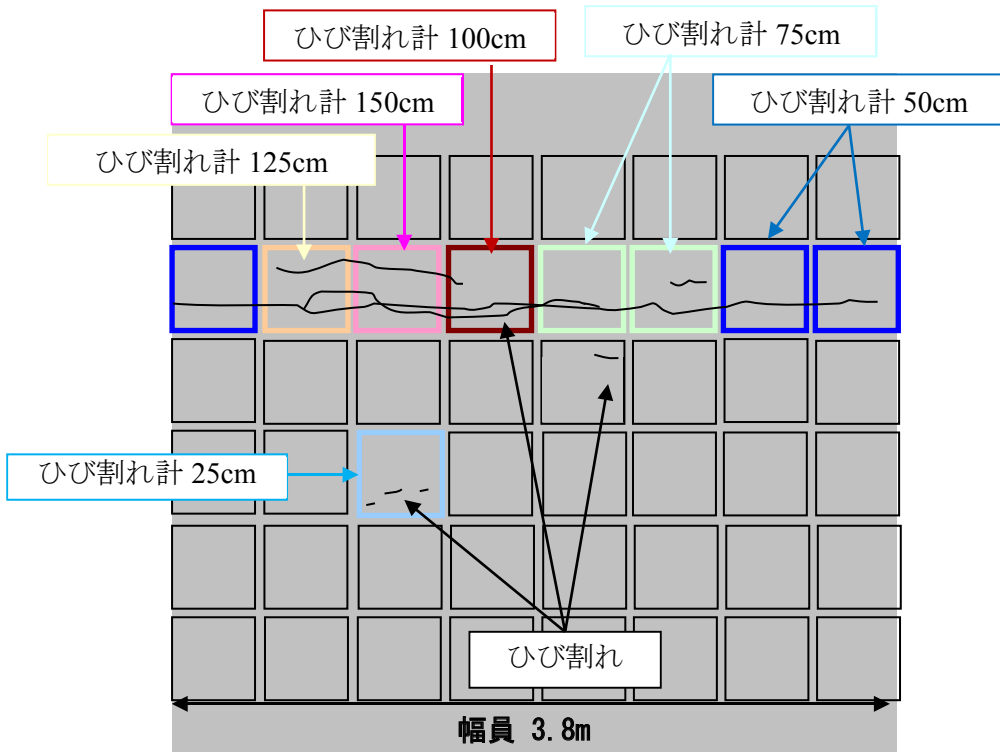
コンクリート舗装におけるひび割れ判読の例
